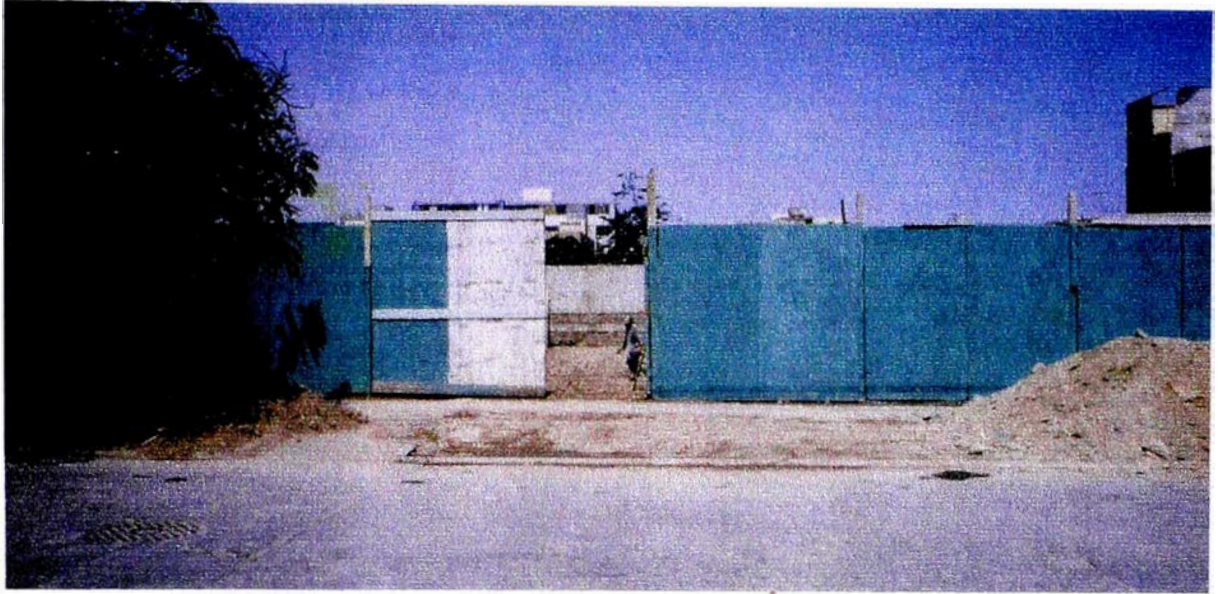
Cerco provisional de la Obra construido en paneles de triplay 19 mm.
